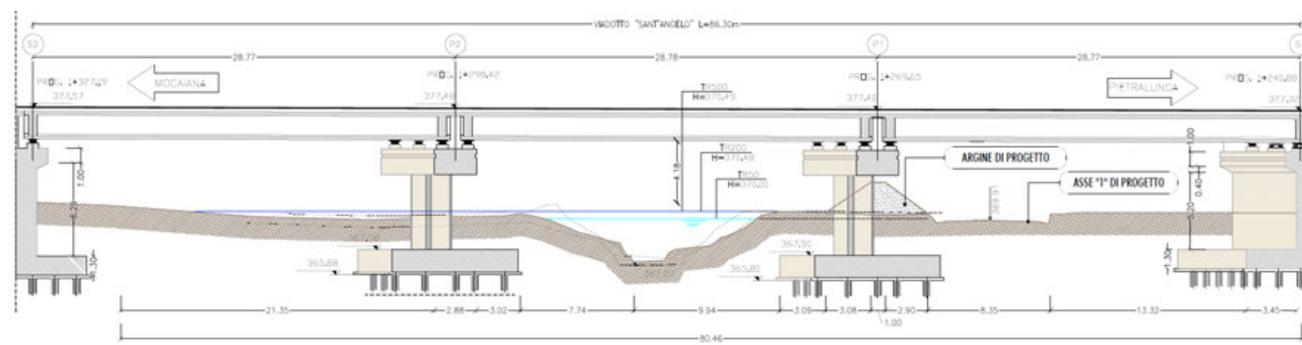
Viadotto S. Angelo e Asse “1” nella configurazione di Progetto Definitivo
